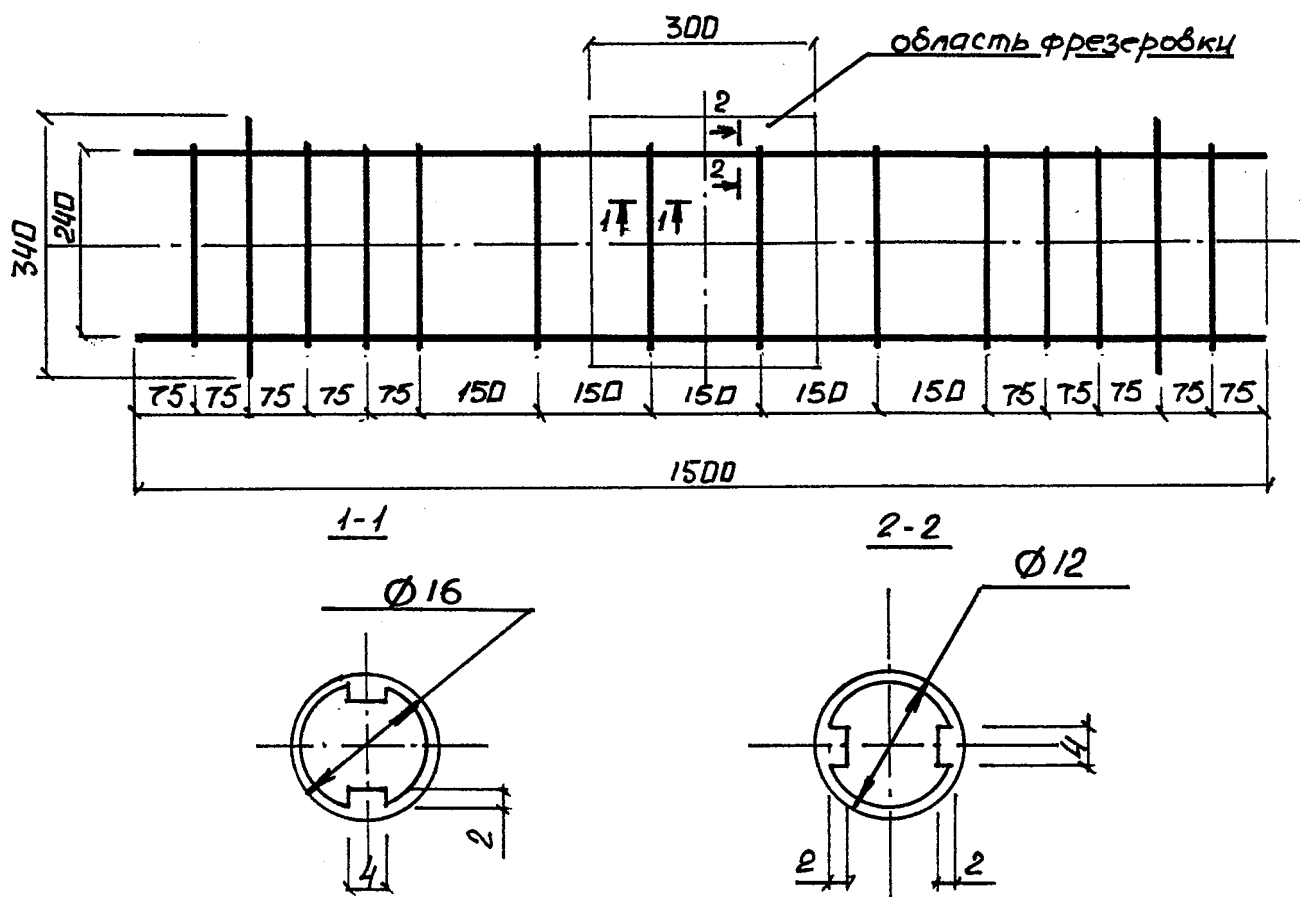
Каркас железобетонных и сталежелезобетонных образцов
